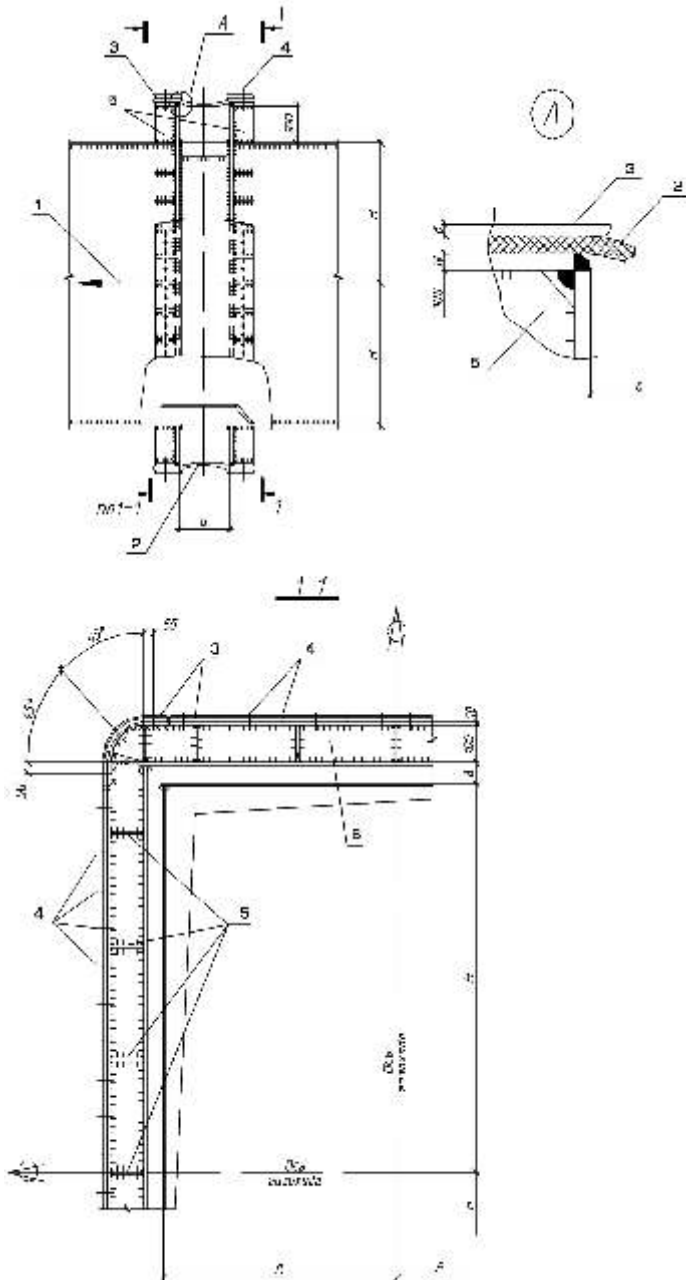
Гибкий компенсатор на прямоугольной трубе:
